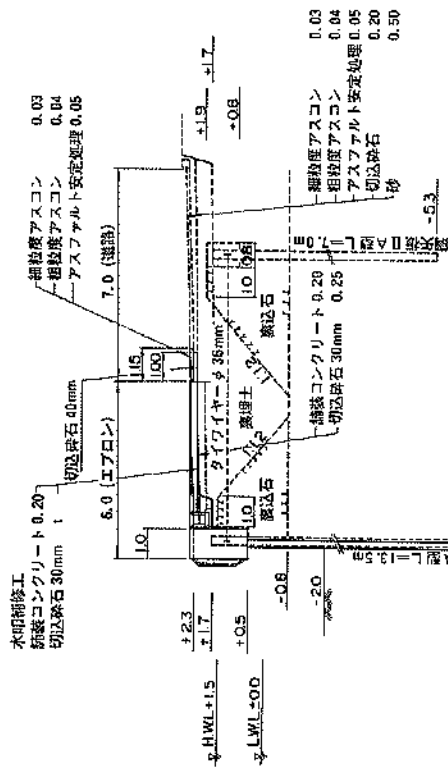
厚岸漁港 (海南地区) ⑨-2.0m物揚場標準断面図および被災後の変形図
